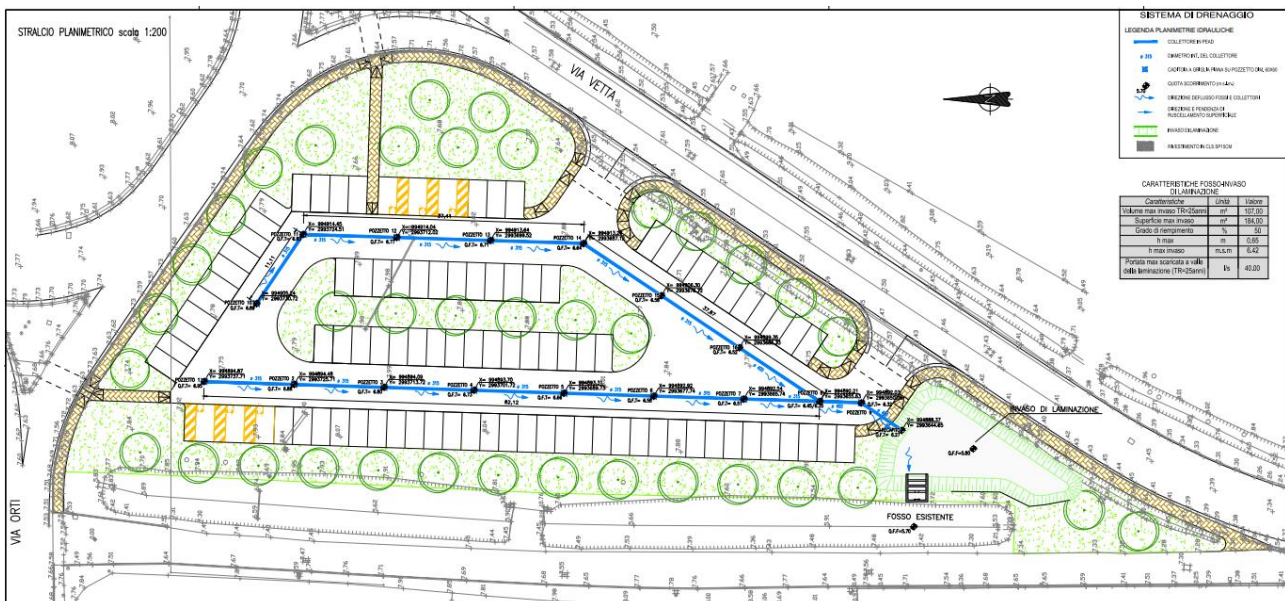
Planimetria della rete di drenaggio del PK002
